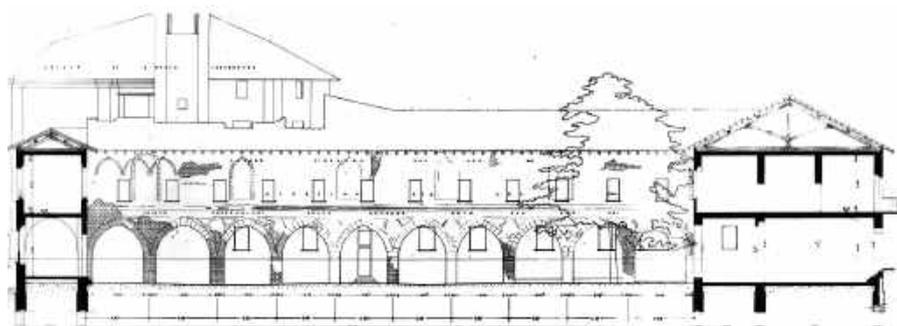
Sezione del chioostro ovest, prima dei lavori di restauro
